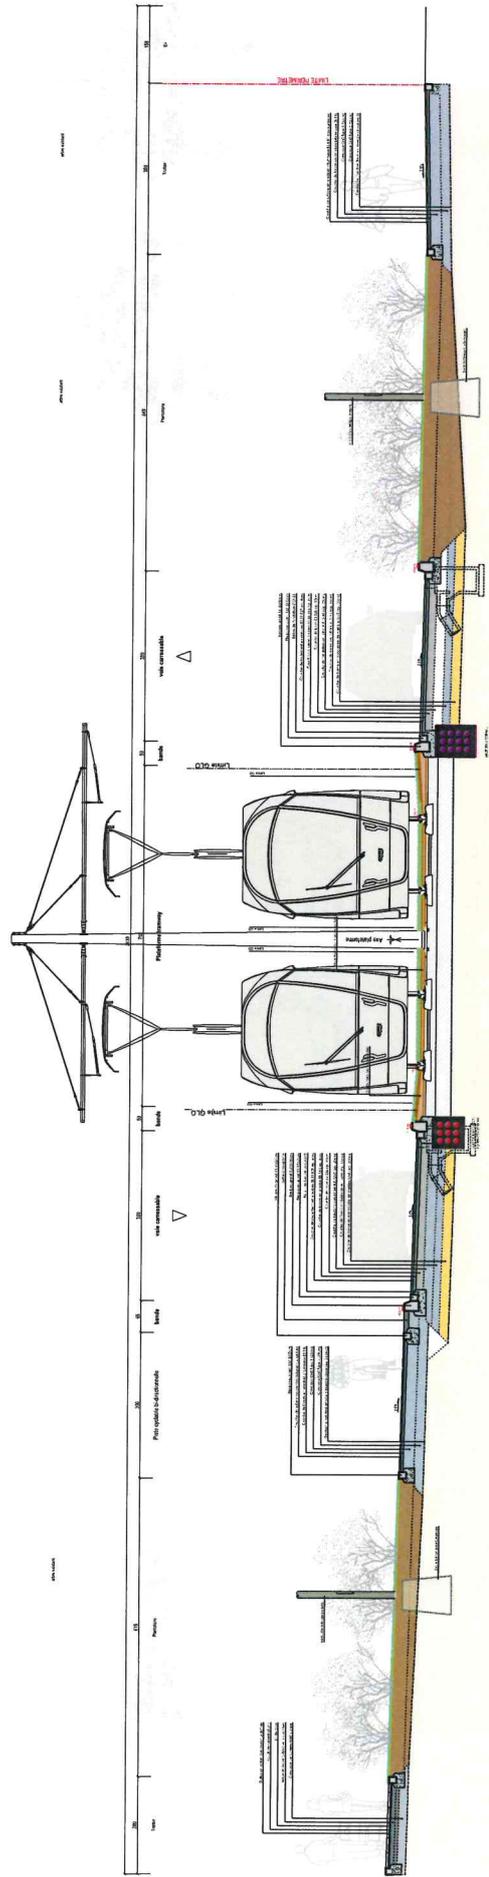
PLATEFORME TRAMWAY ET SALLANGIERS MINÉRALES
